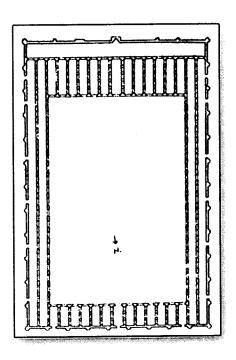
جامع أبي دلف (مسقط أفقي) عن ، كريزول
